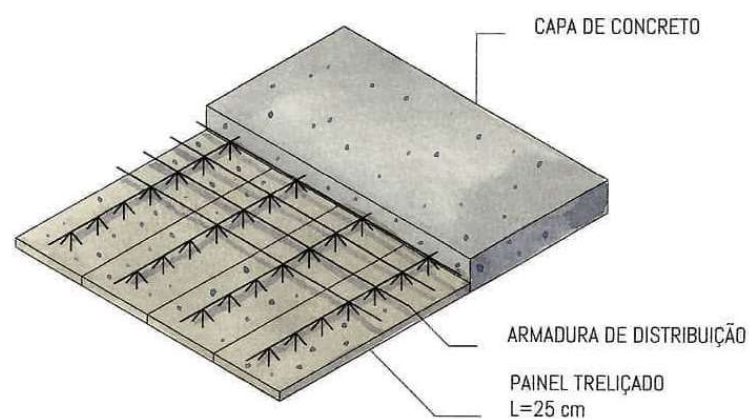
exemplo de Laje Pré-moldada com painéis treliçados.
